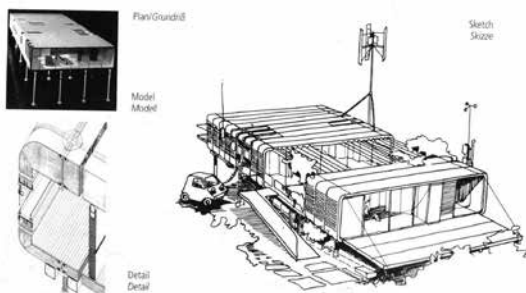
Zip House, Richard Rogers, 1968_ Esquema construtivo (Burdett 1996)
